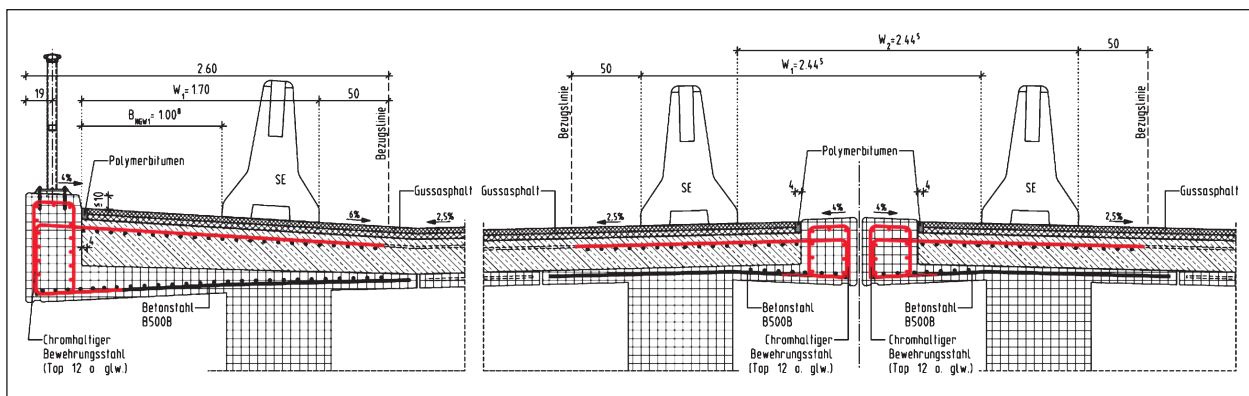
Detail – Randausbildung (Außenkappe und Mittelkappe)
